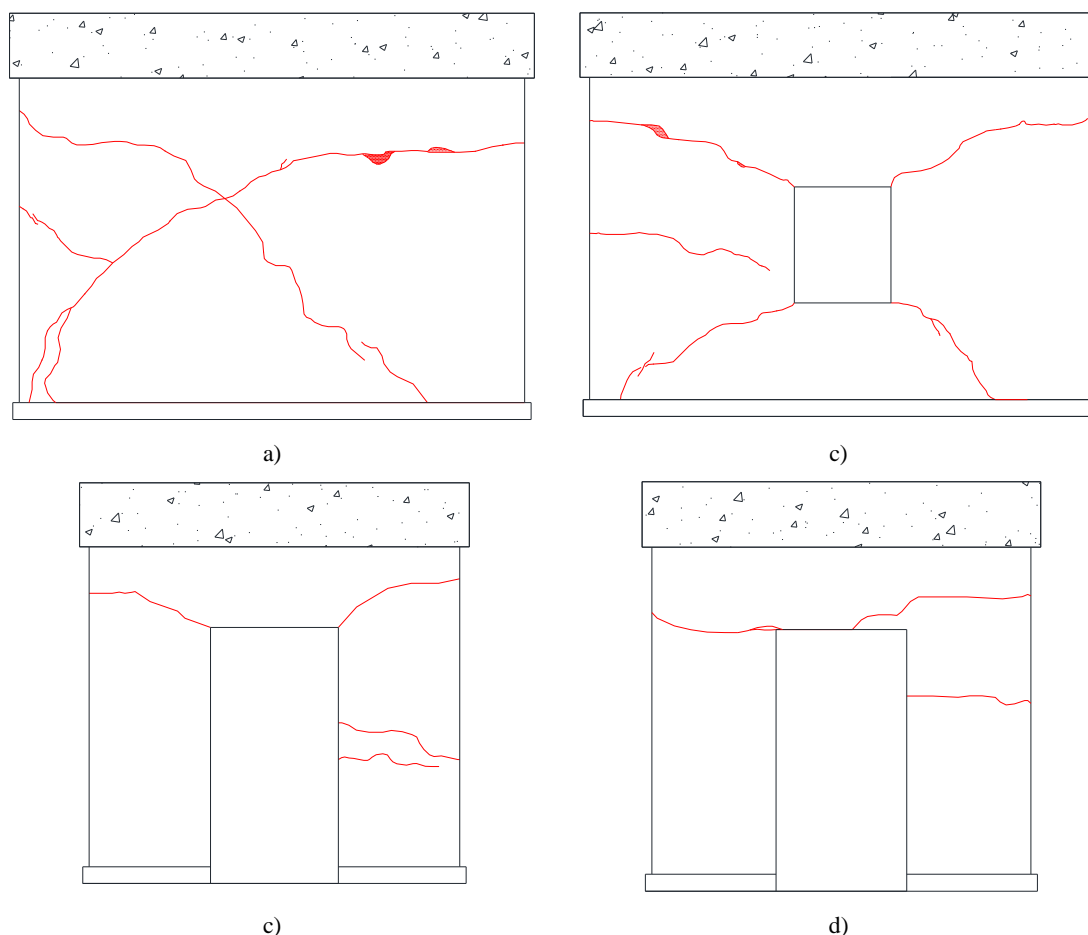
Fissuração no final do ensaio do modelo original: a) Fachada Norte b) Fachada Sul c) Fachada Oeste d) Fachada Este (Carvalho, 2013)
